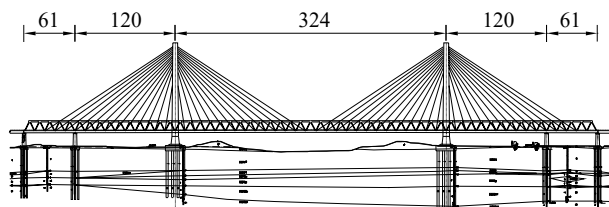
裕溪河特大桥全桥立面布置示意图(单位: m)
